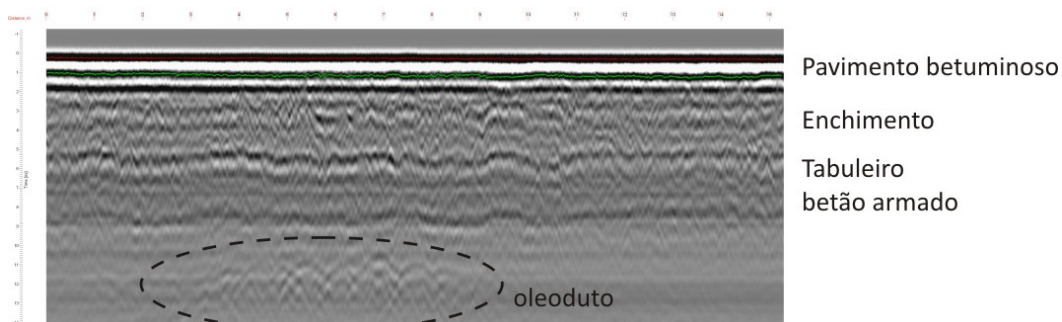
Exemplo dum radargrama longitudinal dum viaduto onde se pode observar a espessura da laje do tabuleiro e o enchimento (de saibro) entre o pavimento rodoviário e o tabuleiro. Foi possível determinar igualmente a espessura do pavimento betuminoso.
